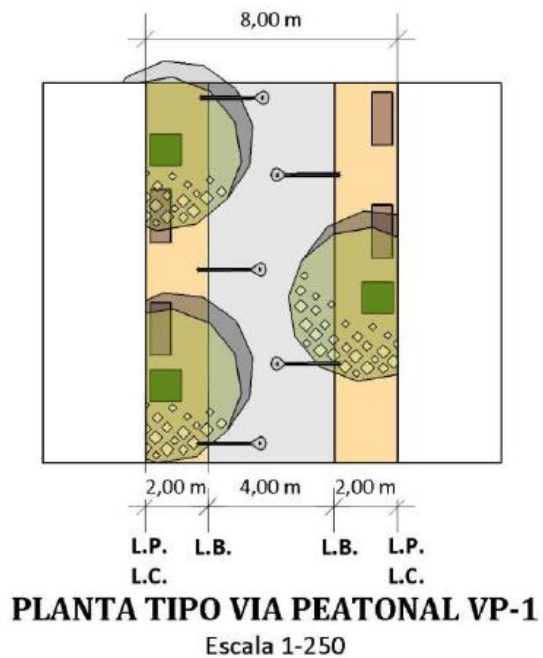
Planta y perfil vial típico Propuesta (VP1 PATONAL)
